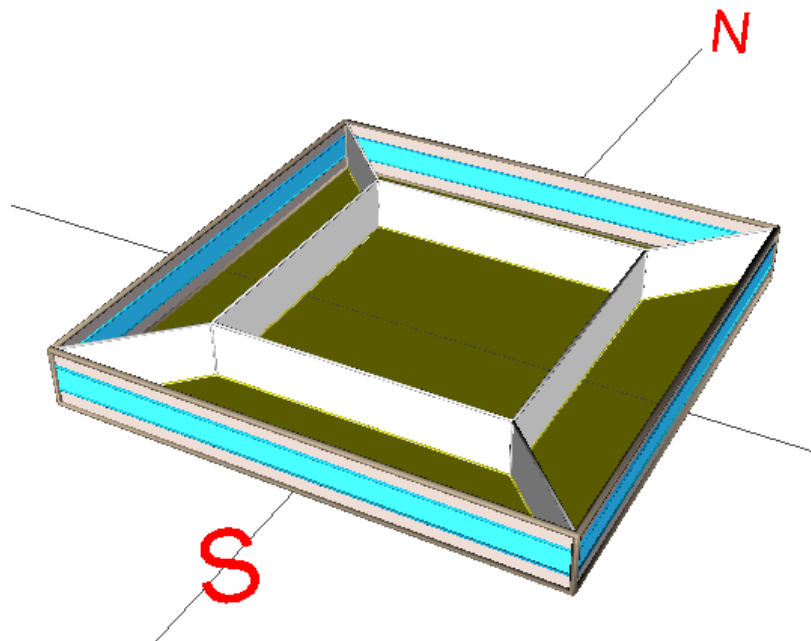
Vista en tres dimensiones del proyecto eliminando la cubierta
